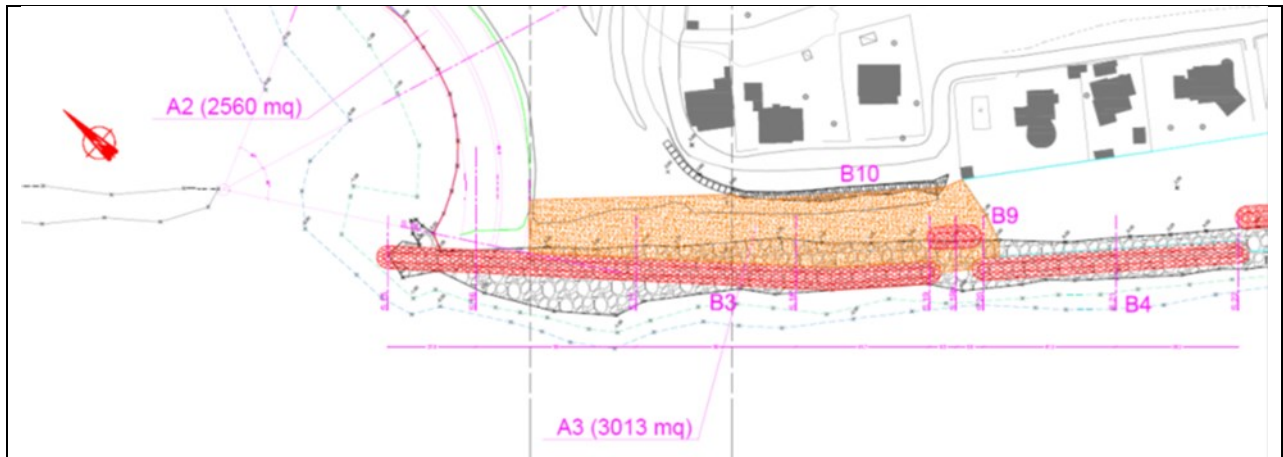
Schema planimetrico intervento Saline area Molaro-Pantanelle
